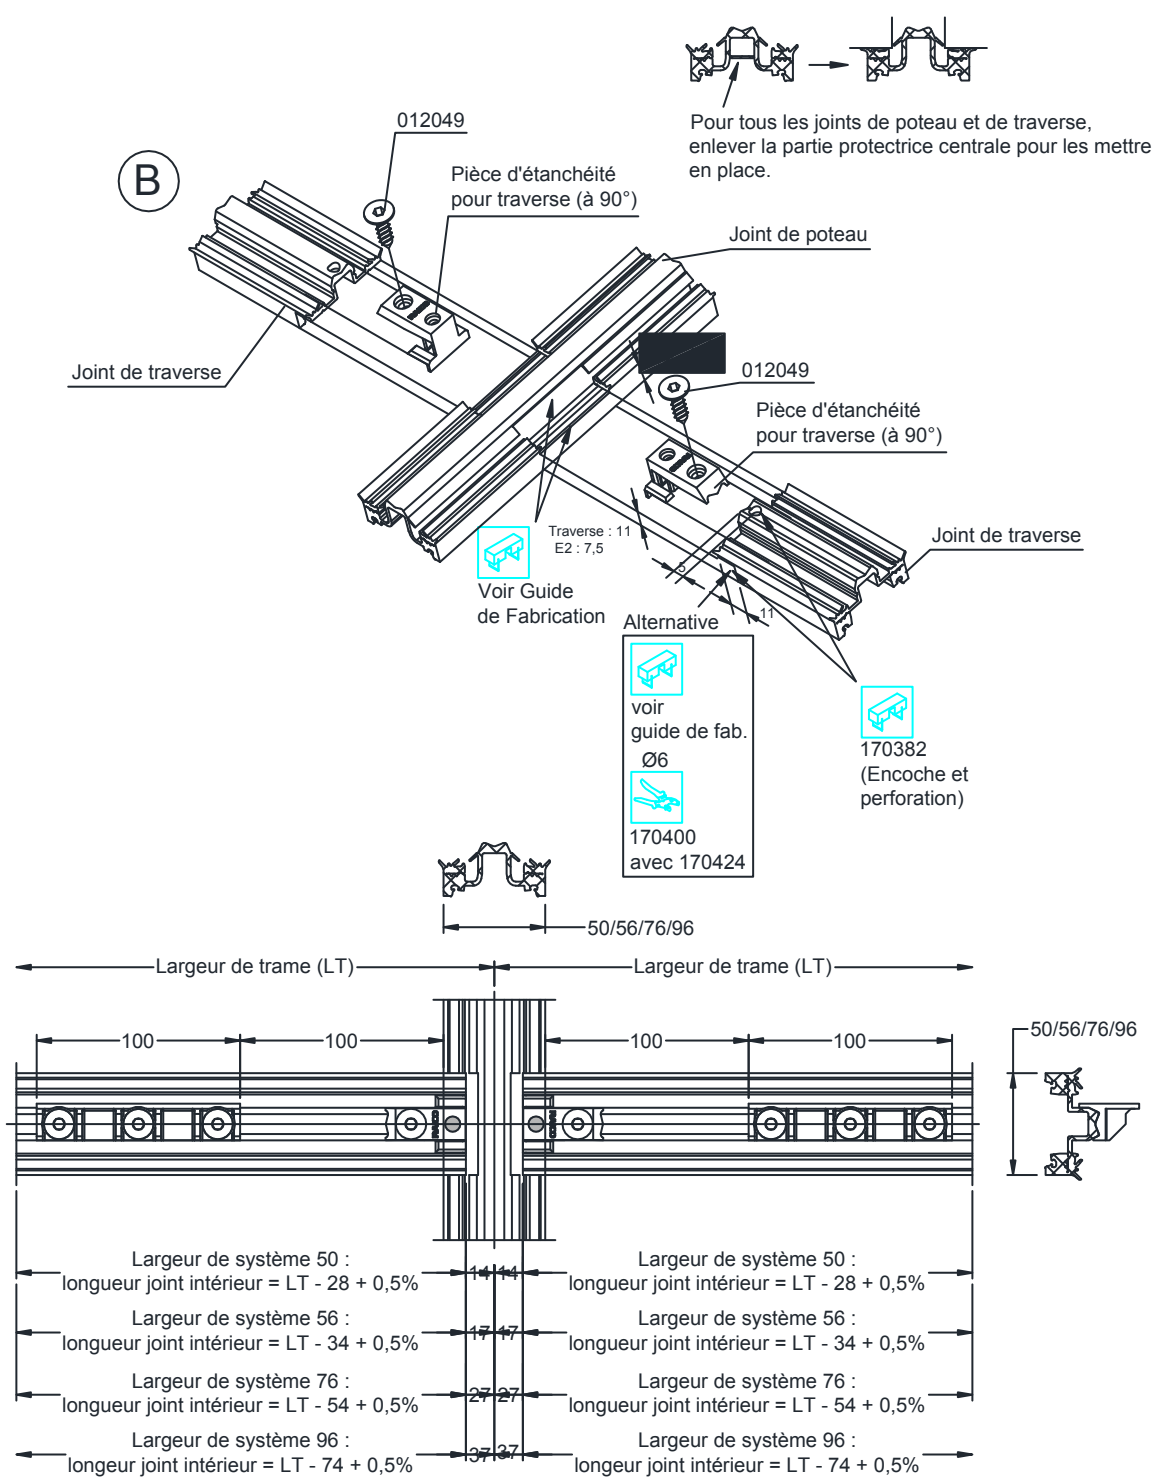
Découpe et usinage des joints intérieurs pour jonctions à 90 : chevron latéral
